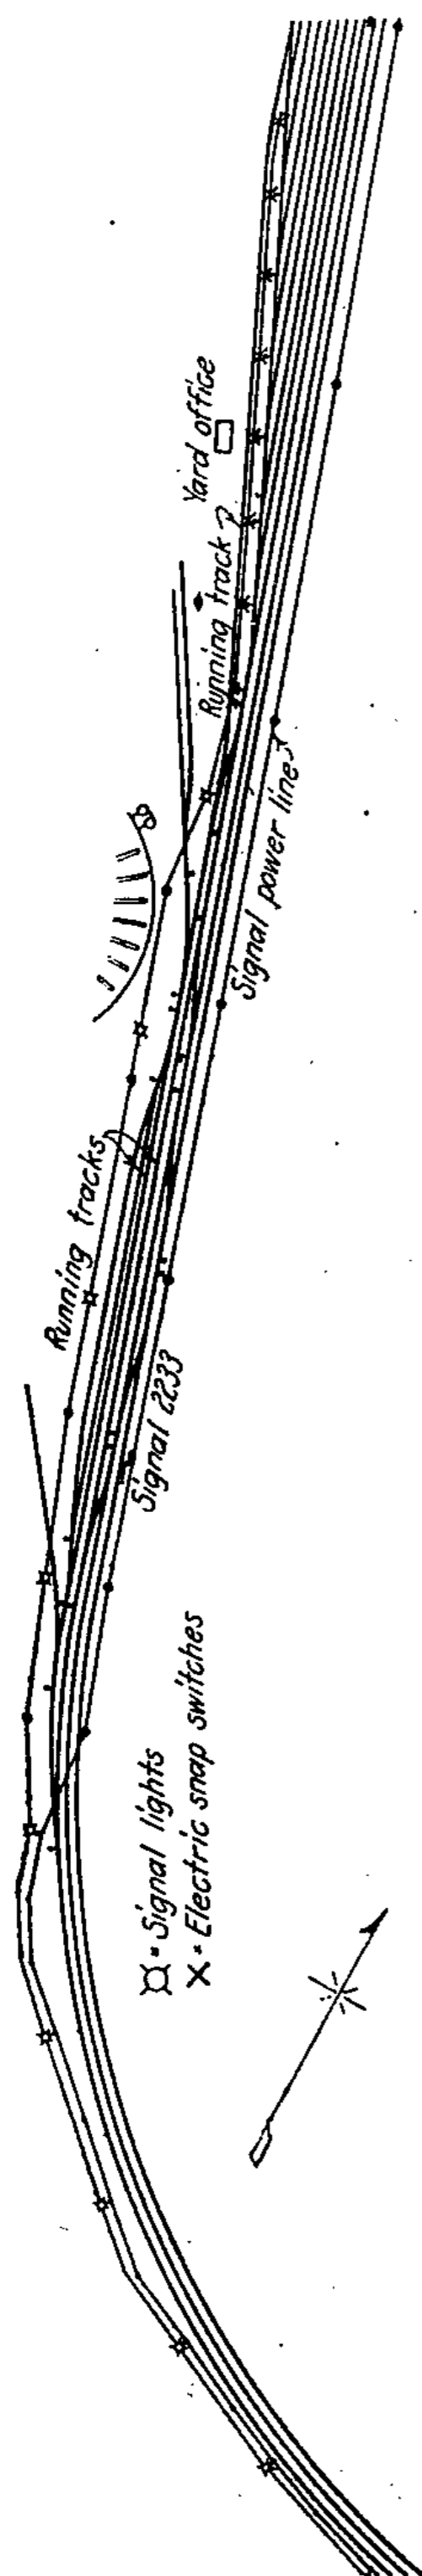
Plan de la gare de Rickers, Pa., montrant l'emplacement des signaux lumineux et des interrupteurs.
